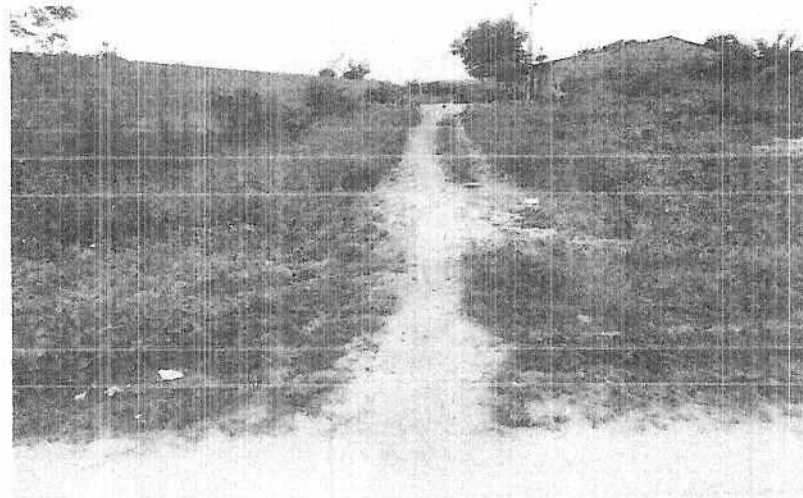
Local de implantação da pavimentação (RUA DEDÉ FIRME, DISTRITO DE CAMPANÁRIO)
